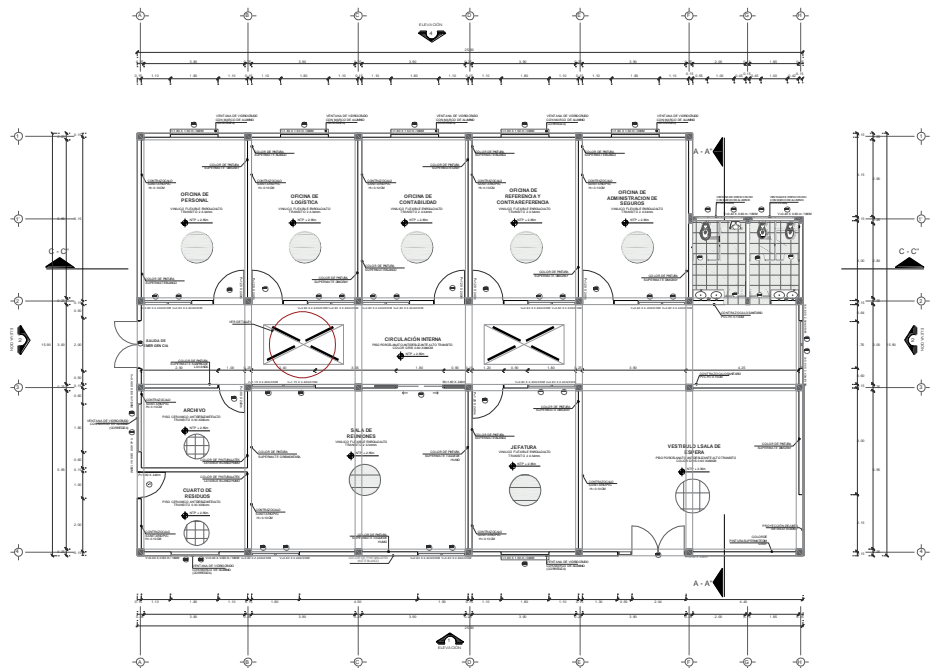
Planta de proyecto - Zona de Administración - Bloque 02. Elaboración propia.
